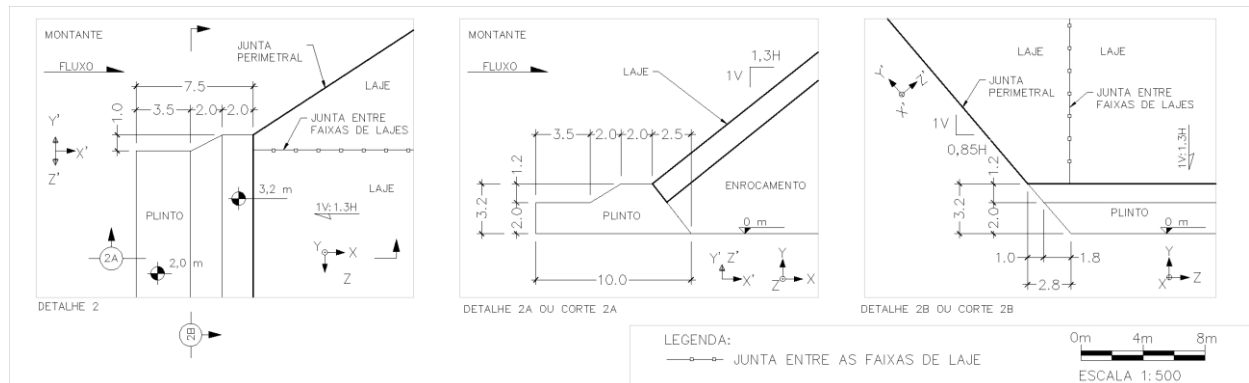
Detalhe 2 com vista superior, Detalhe 2A com vista lateral e Detalhe 2B com vista frontal.
